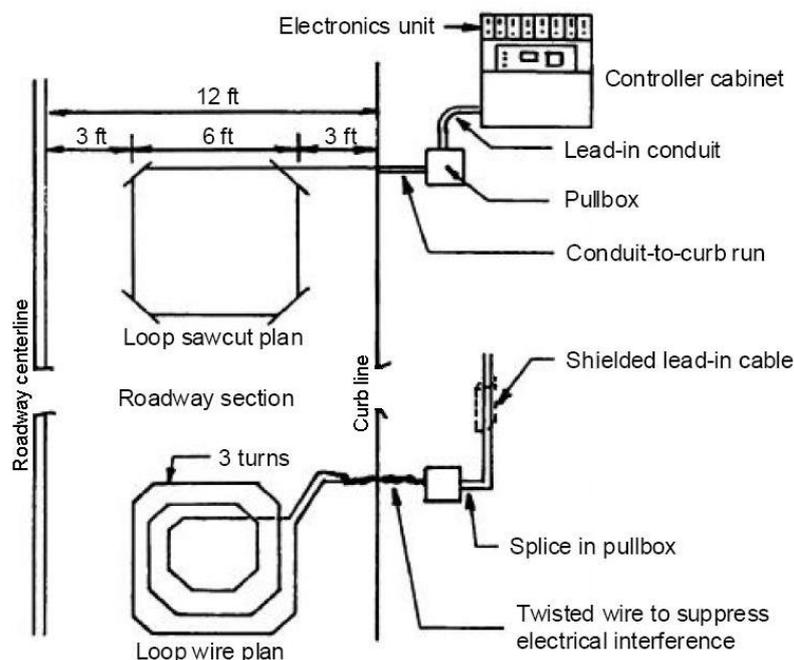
Principais componentes de instalação do sensor de “laço” indutivo
